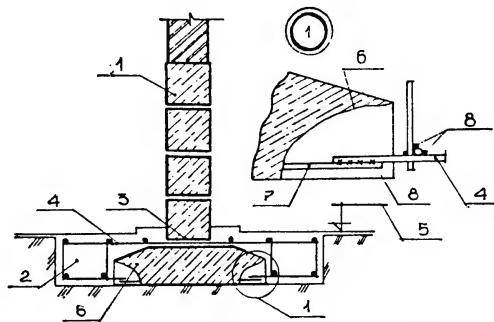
Увеличение опорной площади устройством железобетонной обоймы
